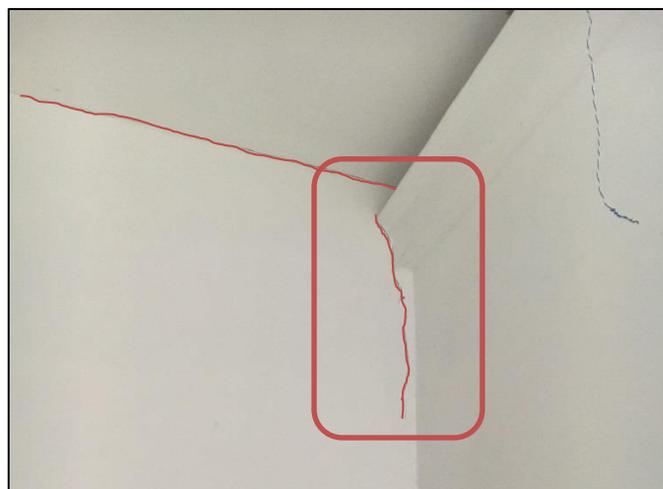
Teatro Zona Lobby – Muros Interiores Fisurados.
